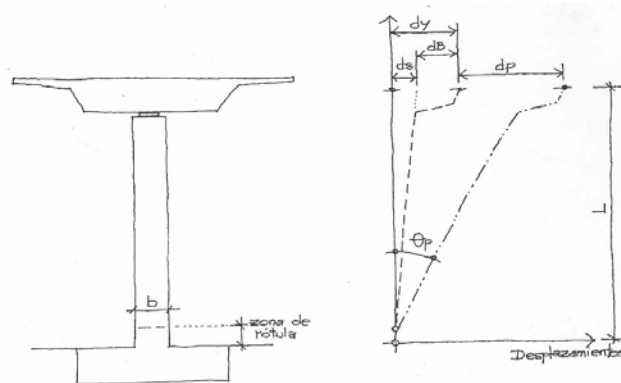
Comportamento di una pila incassata nella fondazione e collegata all'impalcato tramite un elemento in neoprene
